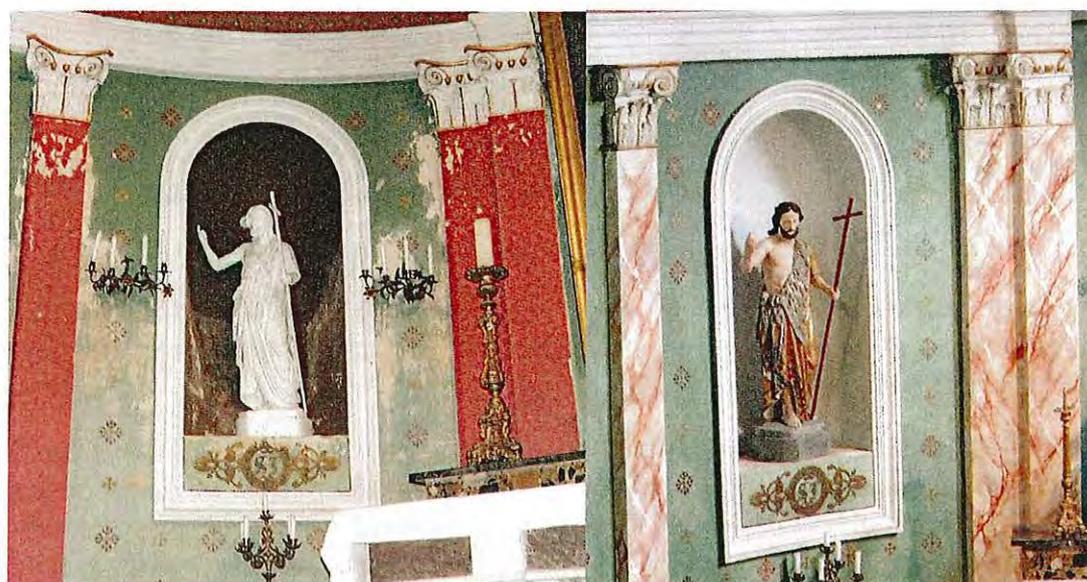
Détails pilastres, murs et niche autour de Jean-Baptiste
